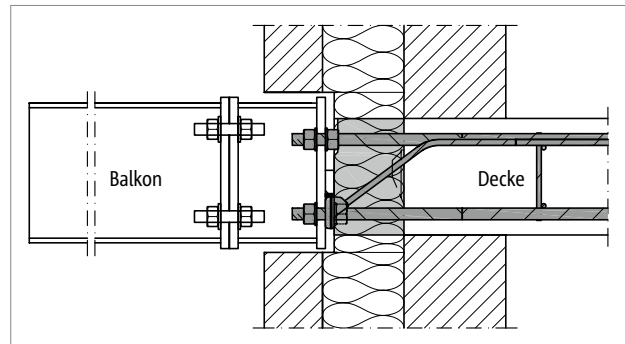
Schöck Isokorb® XT Typ SK: Dämmkörper innerhalb der Kerndämmung; bauseitiges Verbindungsstück zwischen dem Isokorb® und dem Balkon schafft Flexibilität im Bauablauf
